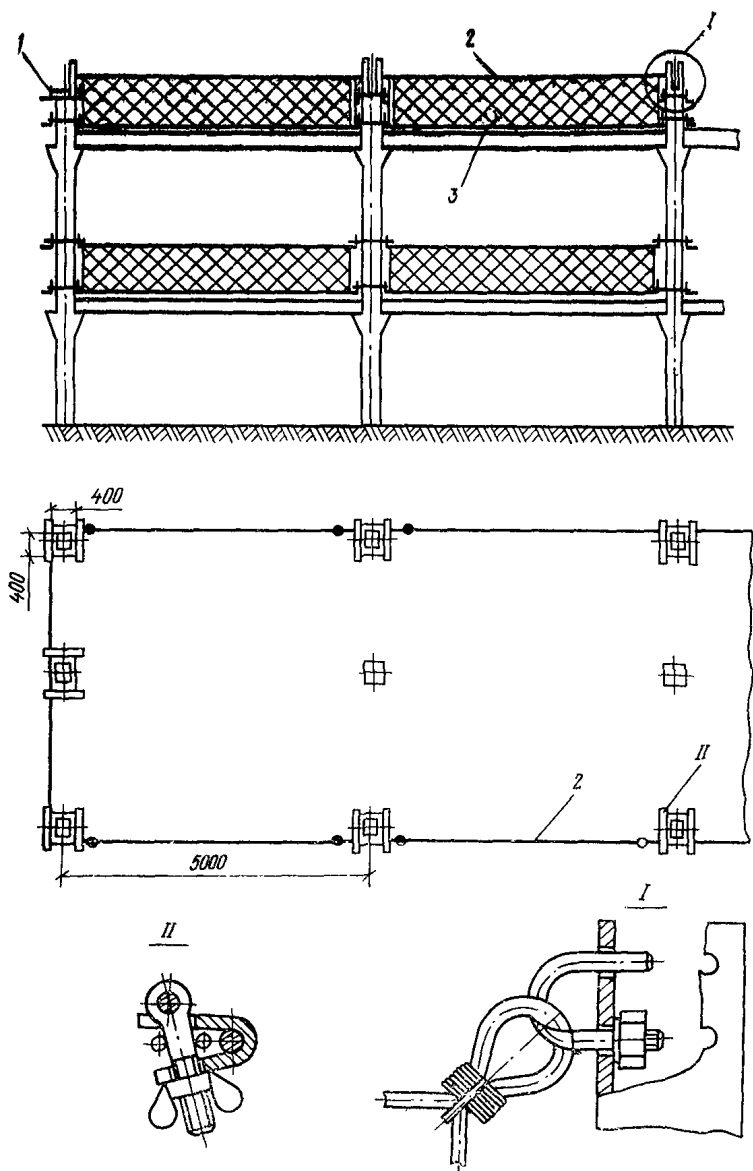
Ограждающее устройство перекрытий каркасно-панельного здания конструкции ЦНИИОМТП
